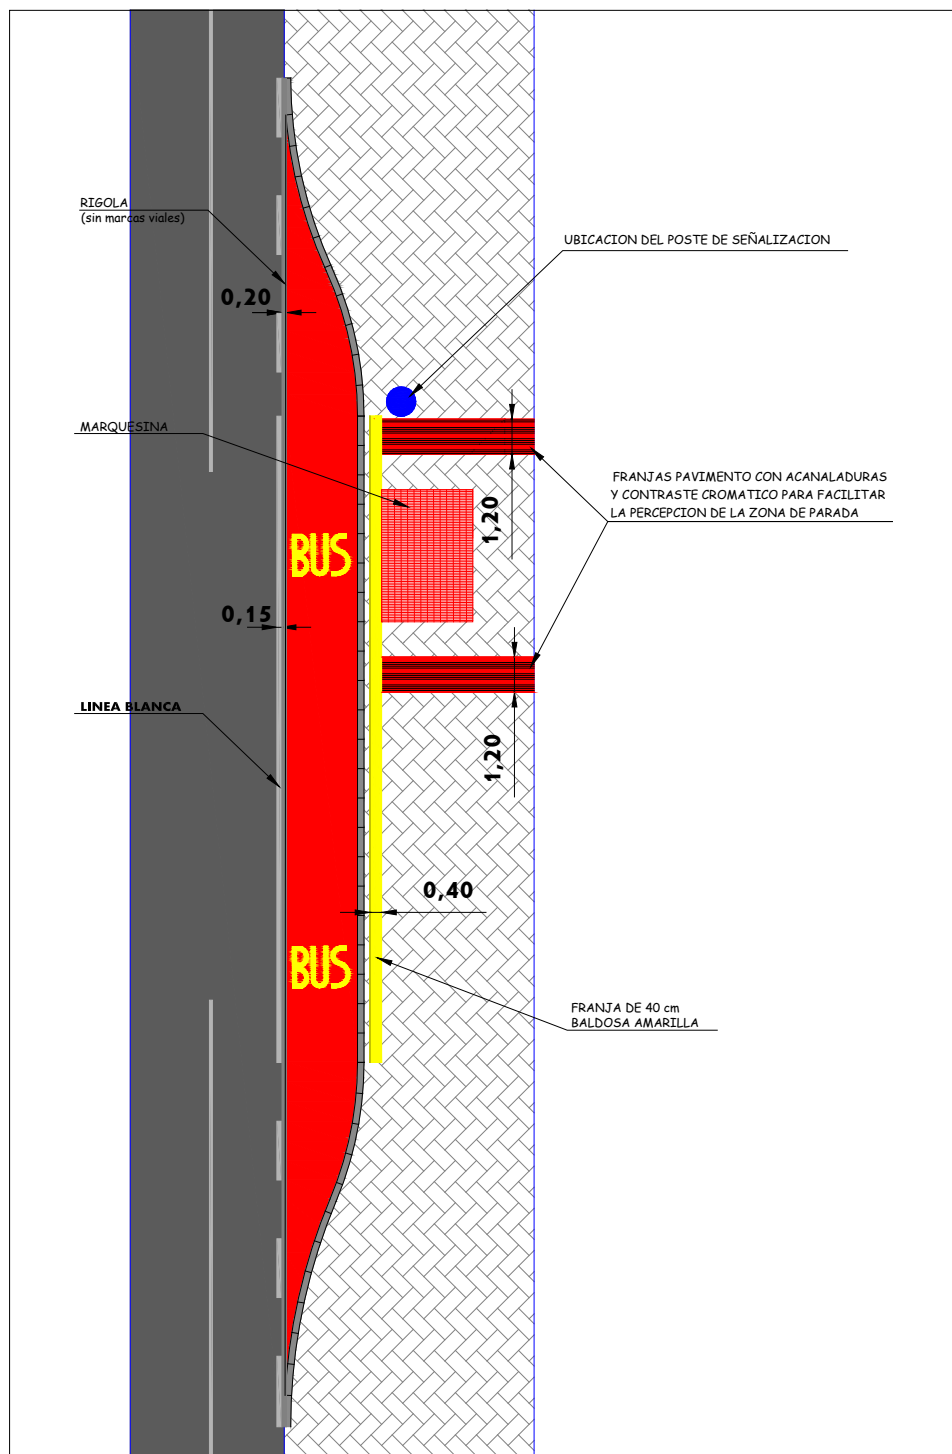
Vista en planta de parada entrante. Ubicación del poste de señalización.
